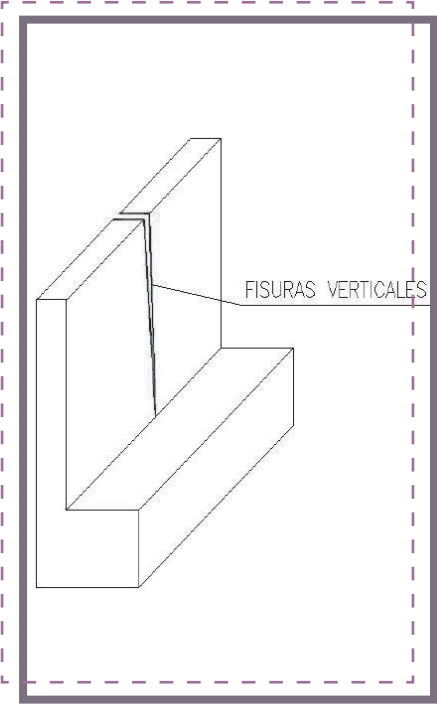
Esquema de fisuración por retracción del muro de contención.
